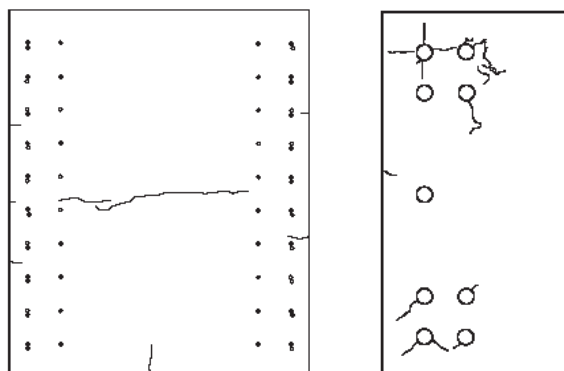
冬期打設の試験体断面のひび割れ（丸山）
